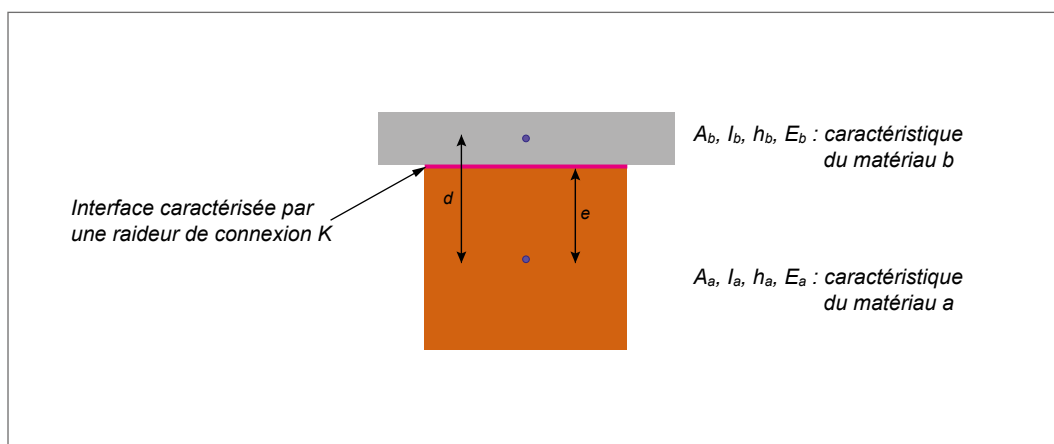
Paramètres caractéristiques d'une section mixte
